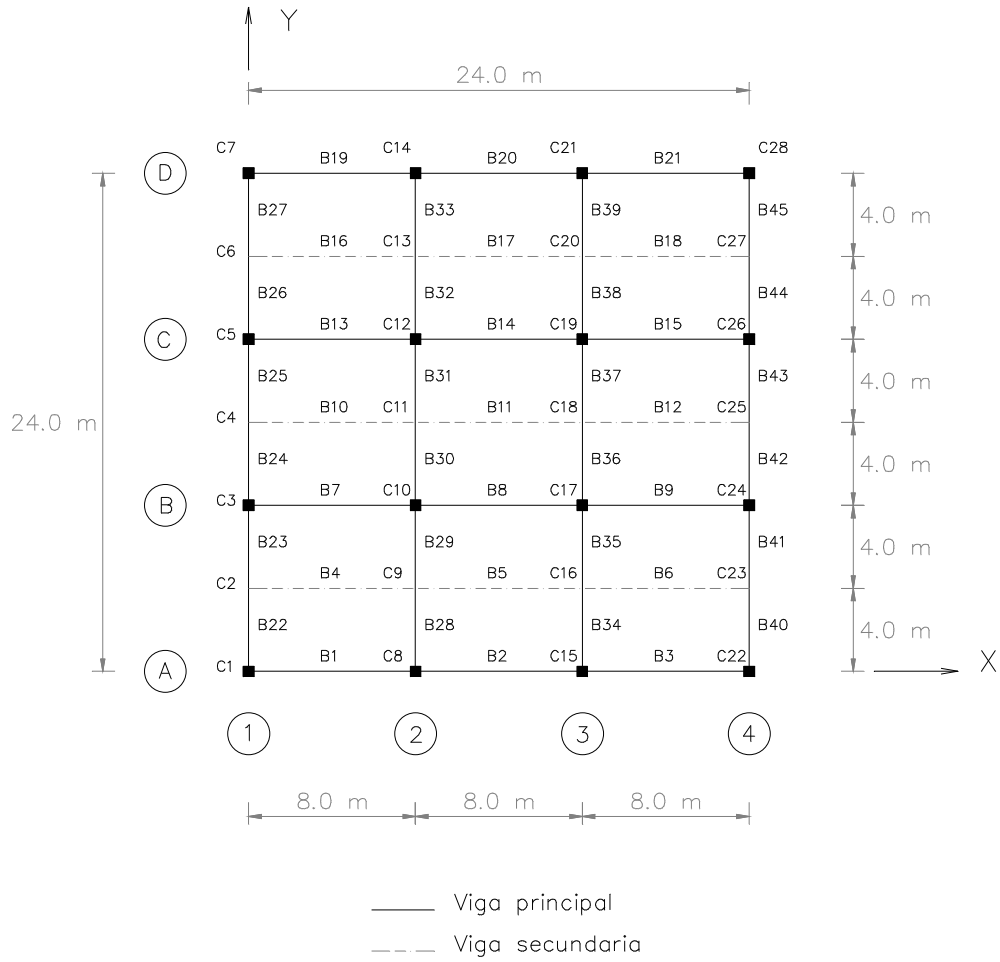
Planta tipo con ubicación de vigas e hileras de columnas del modelo matemático tridimensional, edificios de 7 y 17 niveles
